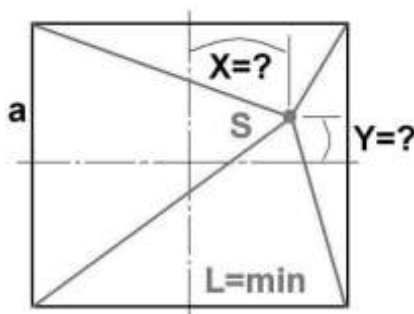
Расчётная схема перекрытия с отклонённой точкой сходимости
